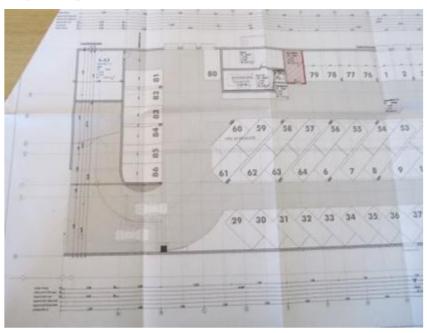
Grundriss Tiefgarage (1/4)
